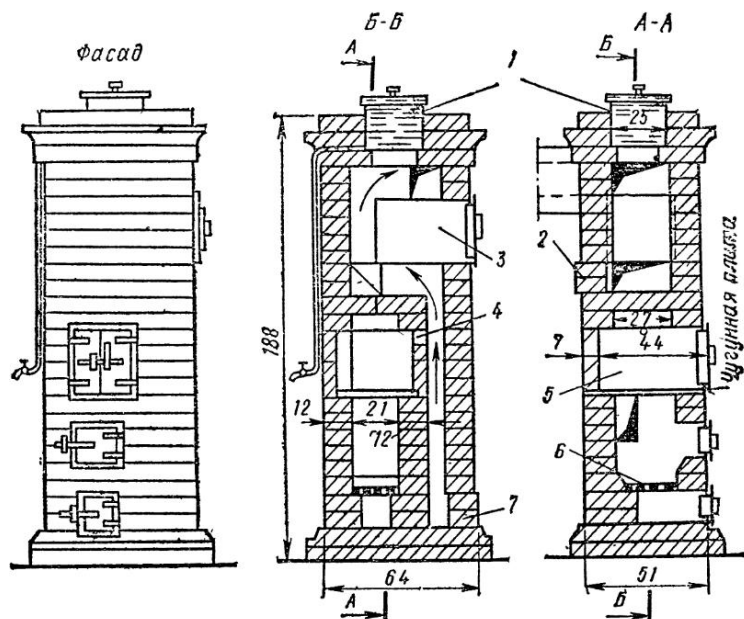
Отопительно-варочная печь конструкции В. А. Потапова
